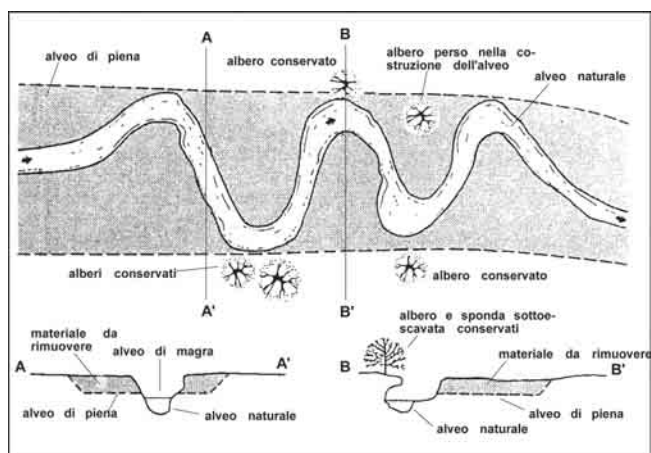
Soluzione dell'alveo a due stadi: pianta e sezioni.
